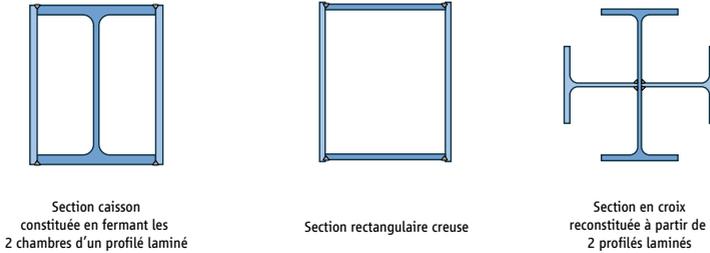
Exemples de sections pouvant être employées pour des poteaux de portiques intervenant dans deux directions de contreventement
